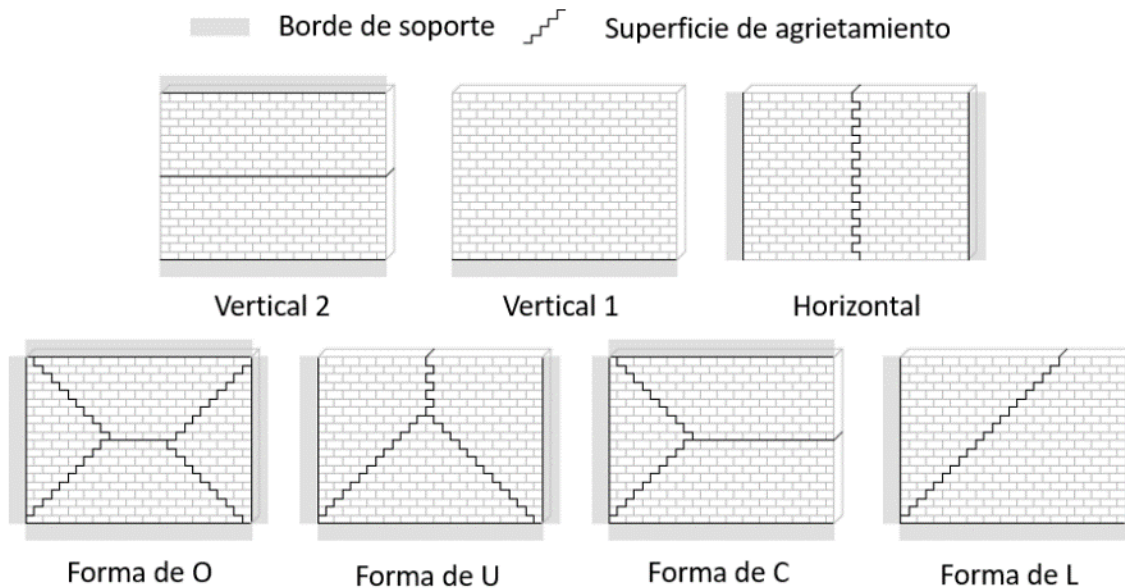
Tipos de falla fuera del plano en muros de mampostería no reforzada.
